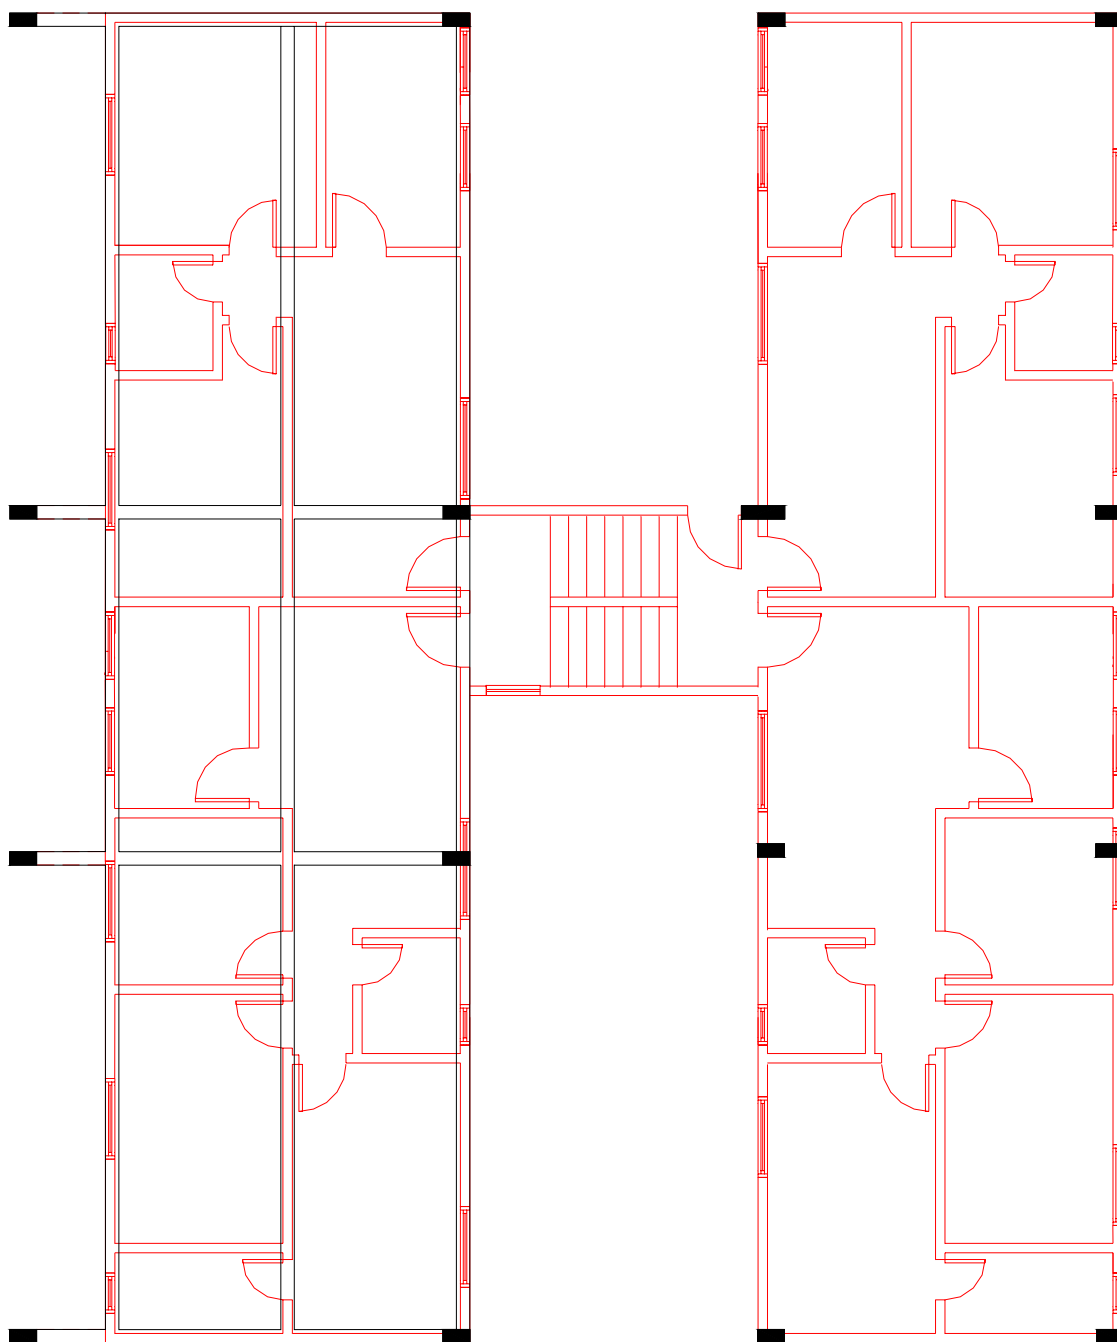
Residencial “J” – Bloco 5 – Superposição das alvenarias do pavimento tipo sobre a primeira solução de vigamento de pilotis
